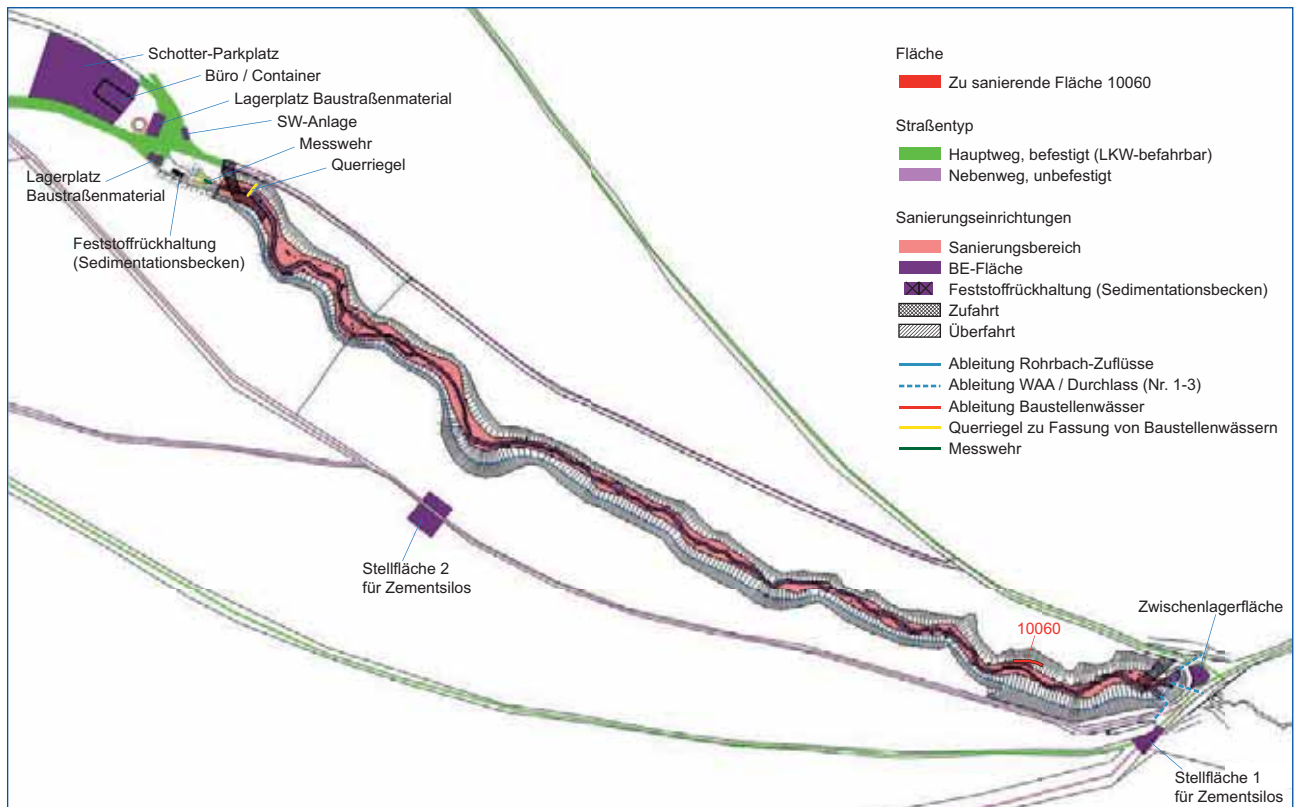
Lageplan Rohrbach-Abschnitt II
